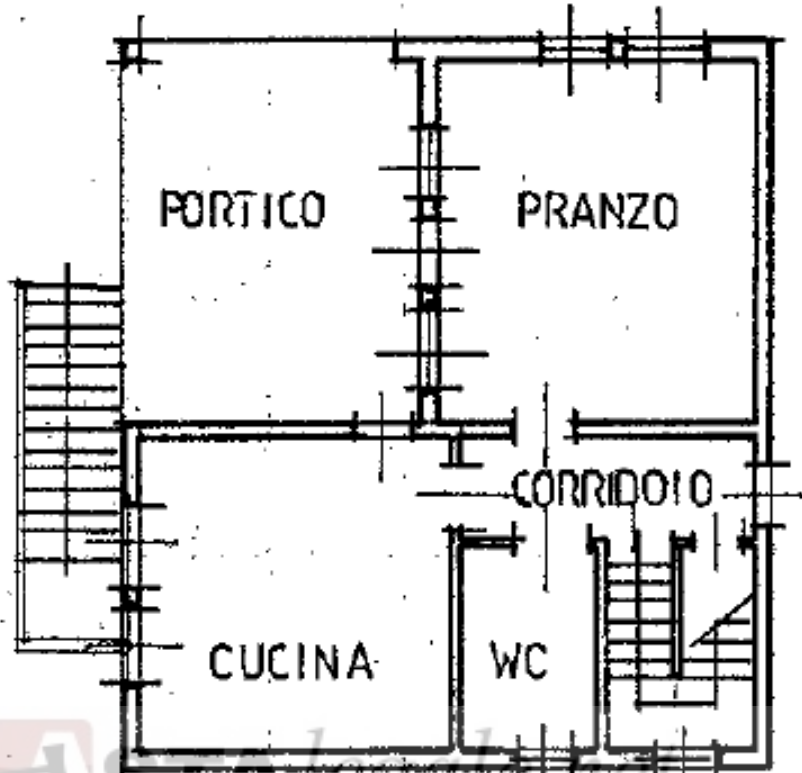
Estratto della planimetria catastale p.lla 330 (piano terra).
